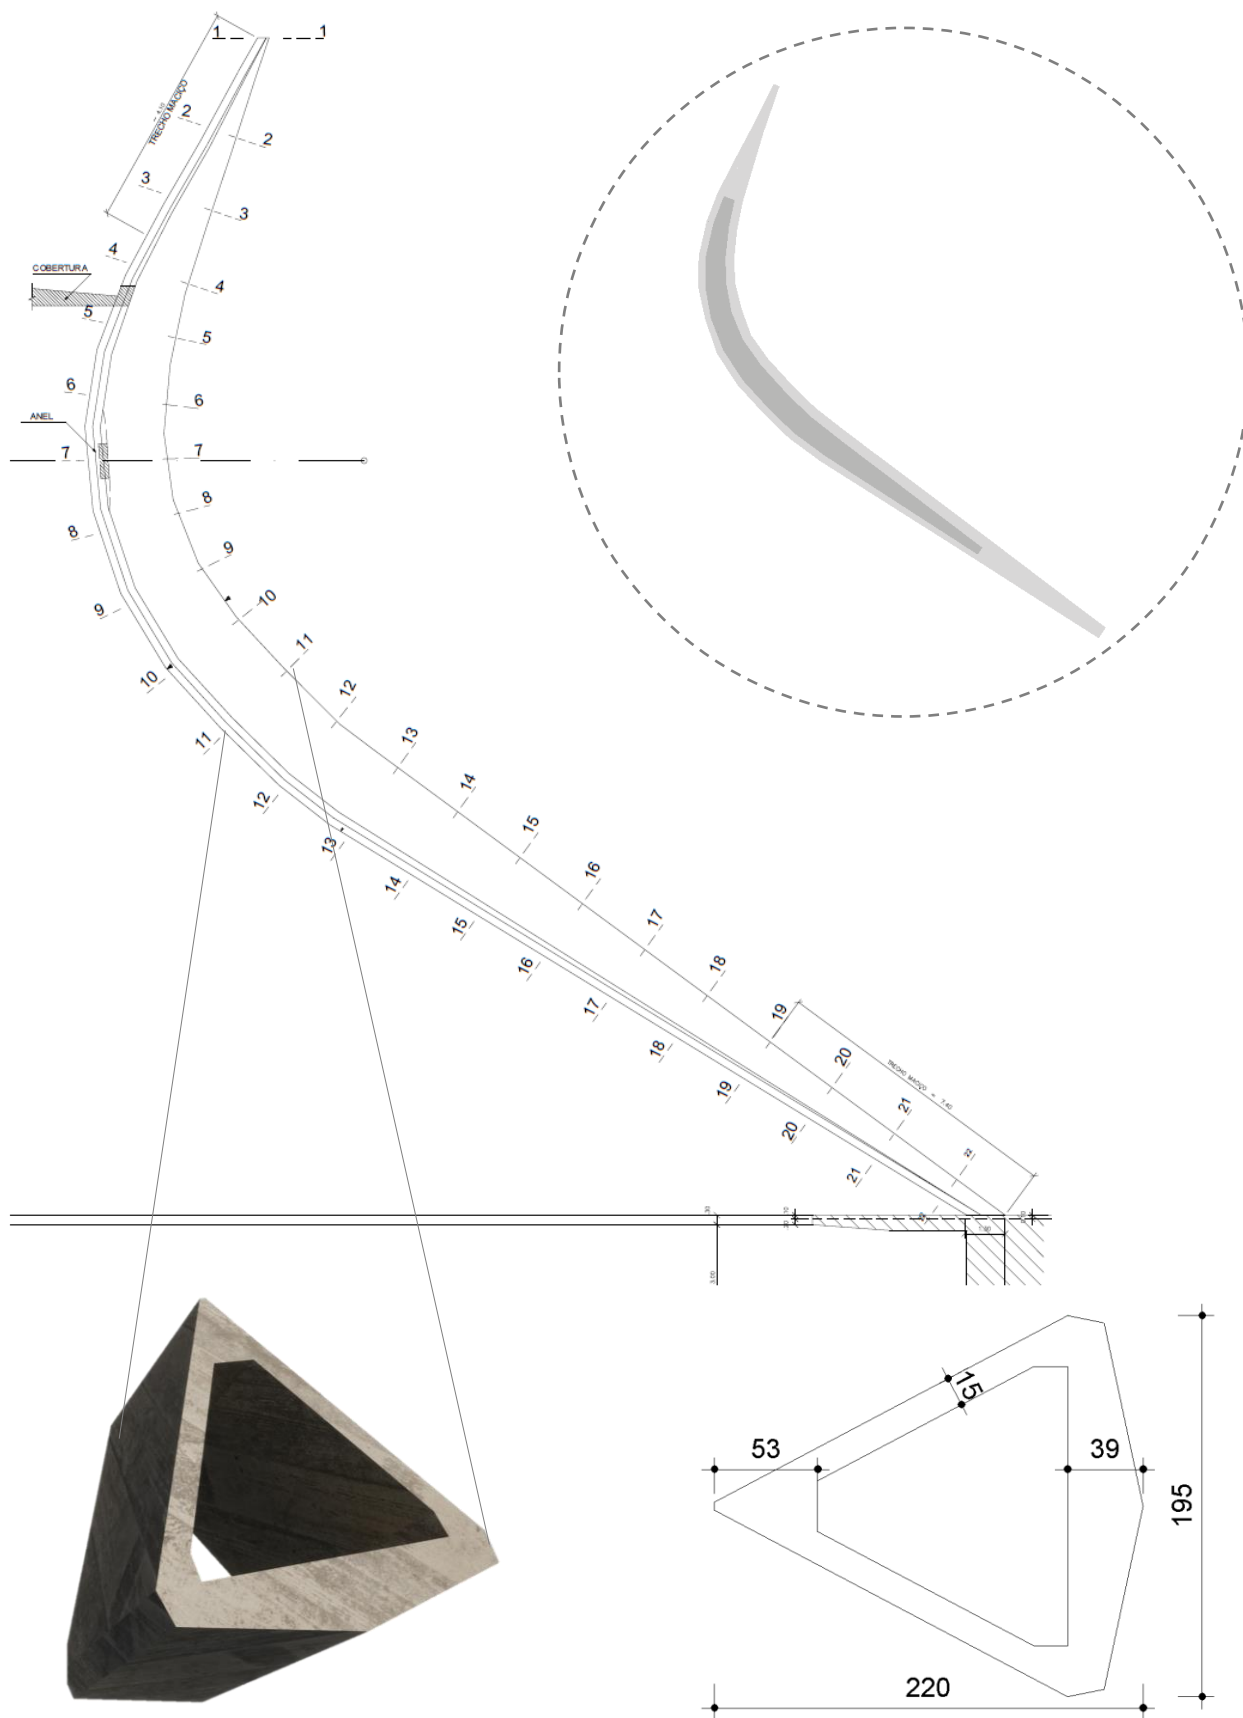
Detalhe do montante da catedral e seção transversal 11.
